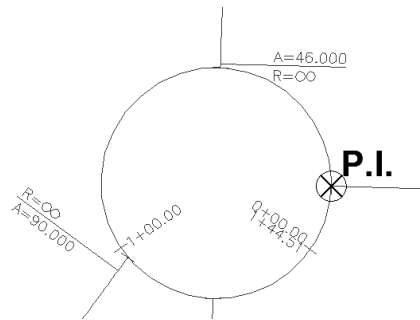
Intersecção em Planta entre o eixo do Ramo 1 e a Rotunda B
